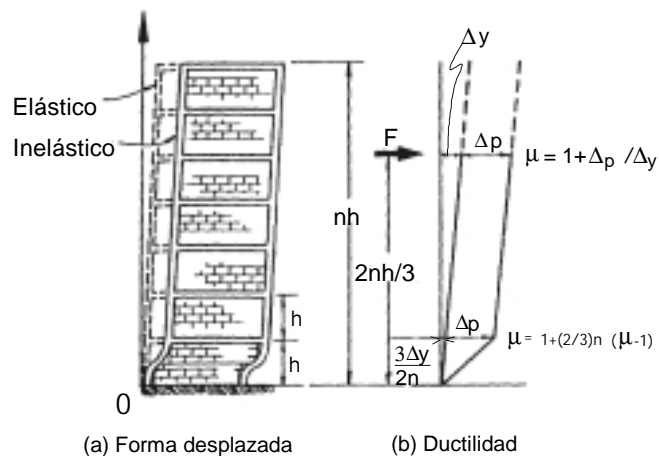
Fenómeno de piso suave producido por desplazamiento inelásticos en planta baja (Paulay y Priestley, 1992)
